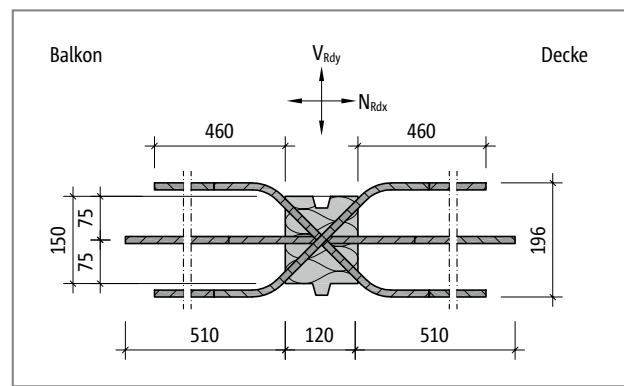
Schöck Isokorb® XT Typ HP-VV2-NN1: Produktgrundriss
